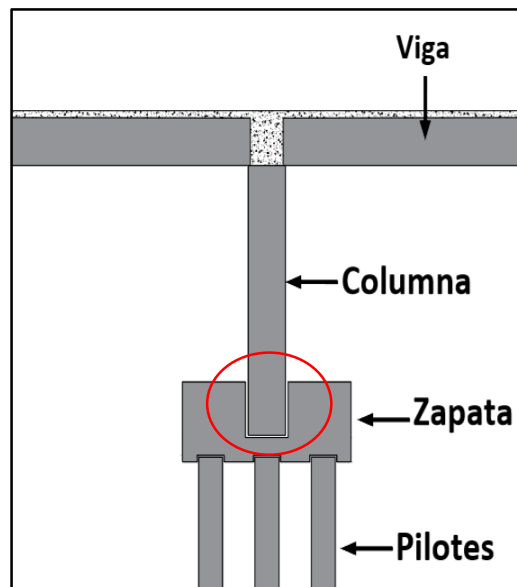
Tipos de elementos prefabricados de hormigón principales para la estructura de un edificio. Se señala con rojo el tipo de conexión a estudiar. Fuente del autor.
